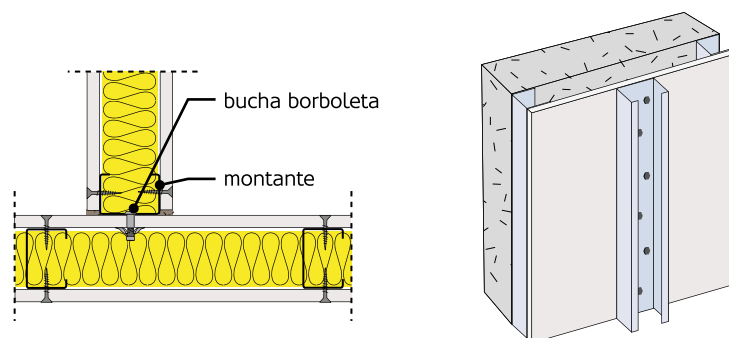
Ligação de um perfil montante de arranque a um sistema existente.
